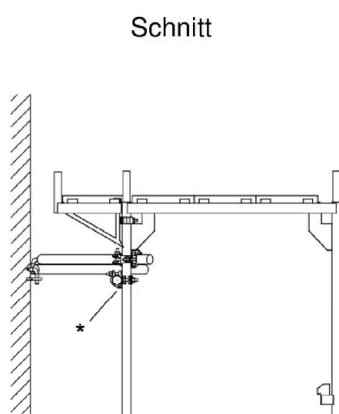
V-Anker mit Gerüstrohraussteifung
